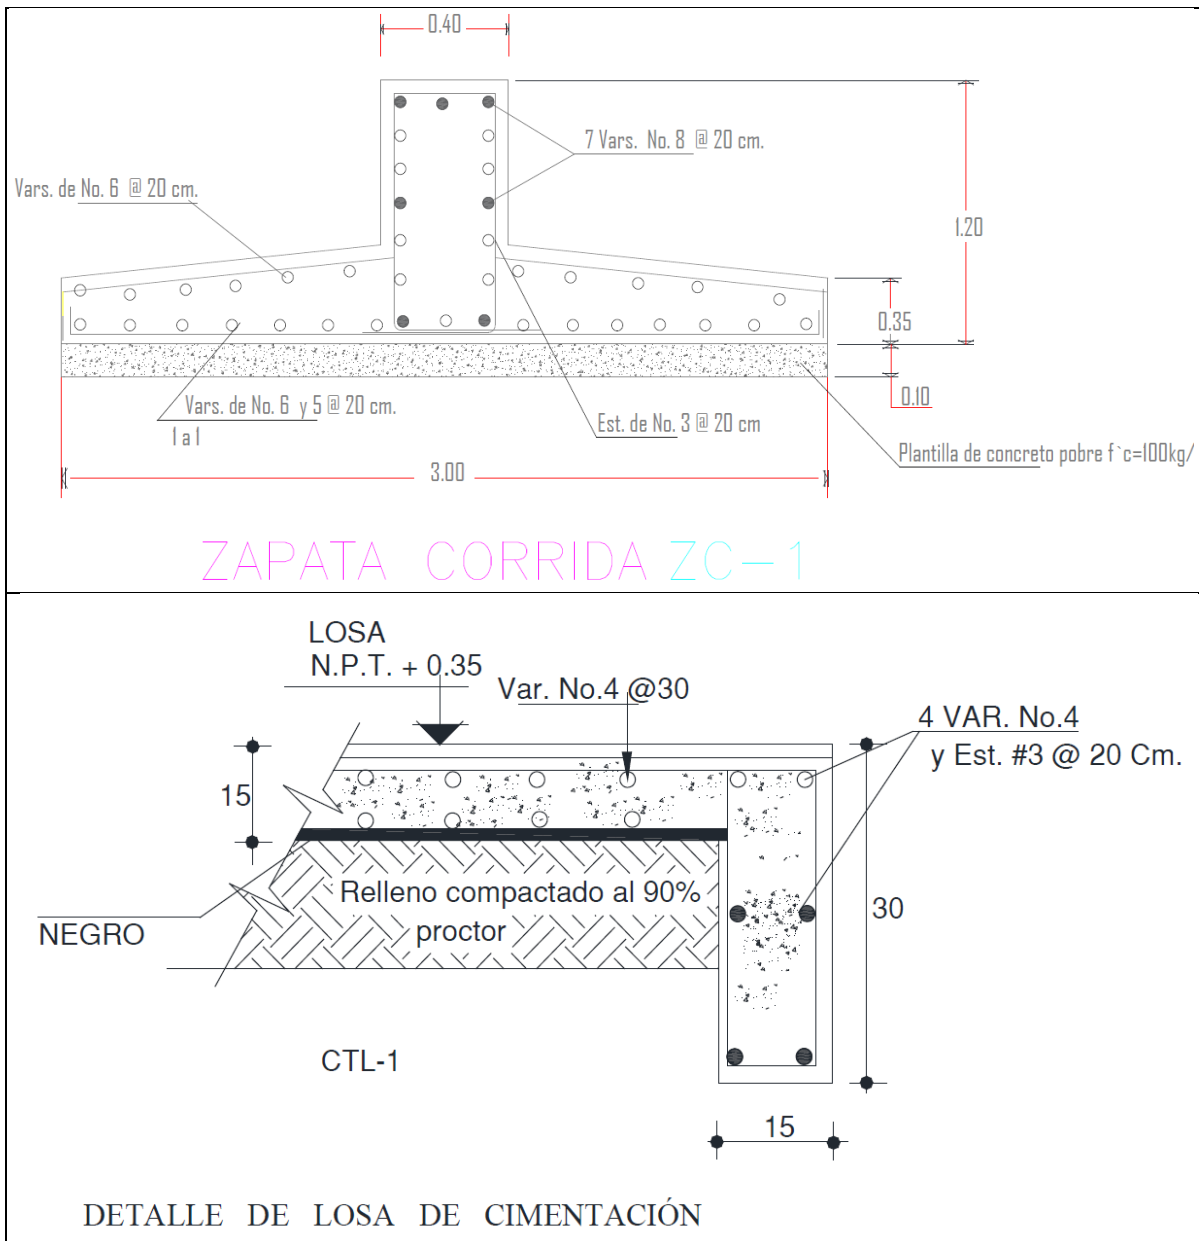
Detalle de la losa de cimentación y Zapata corrida.
